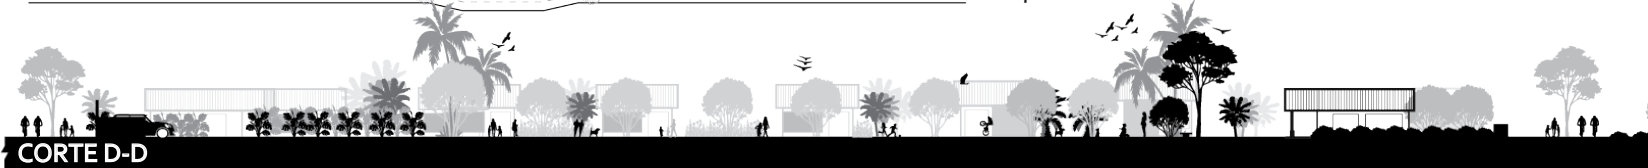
Detalle de amortiguamiento entre plaza central y viviendas
